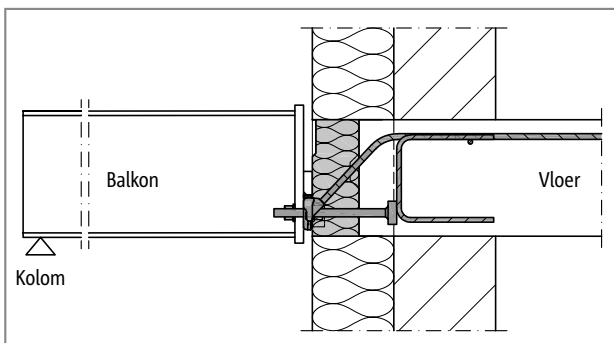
Schöck Isokorf® T type SQ: aansluiting aan de vloer van gewapend beton
